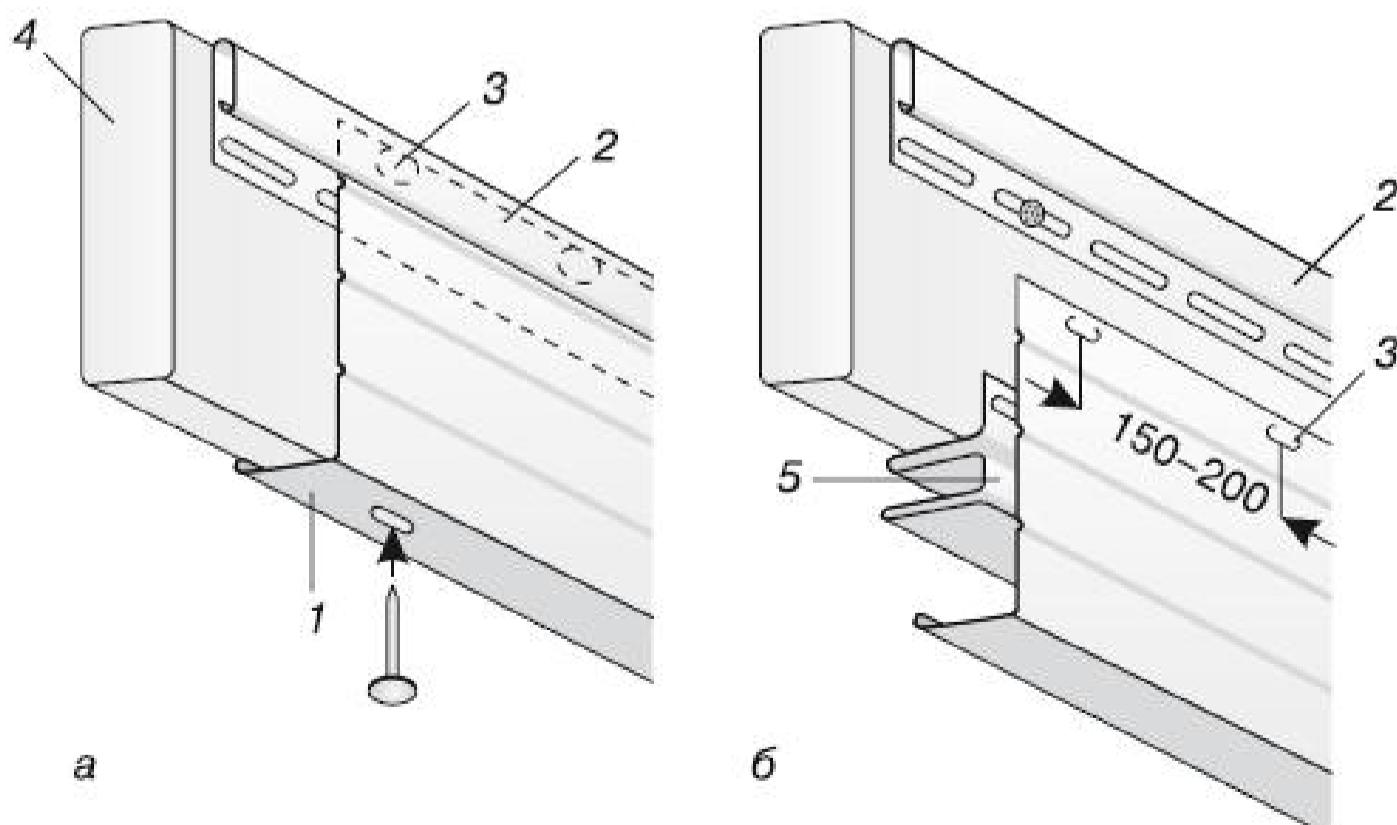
Установка фаски: а – без софитов; б – с софитами; 1 – фаска; 2 – завершающий профиль; 3 – зацепы; 4 – деревянная ветровая доска; 5– F-профиль или J-профиль
